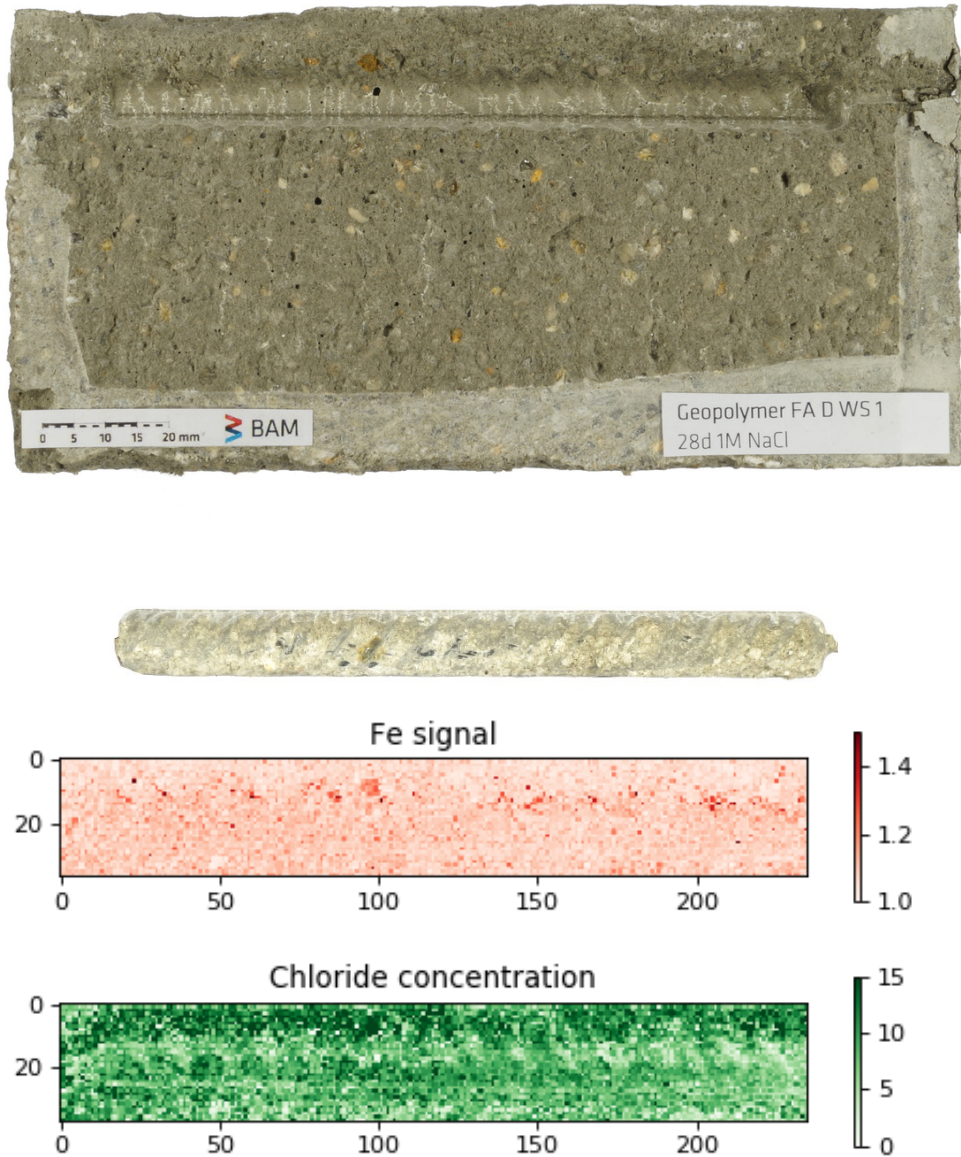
Foto von gespaltener FA D WS 1 Probe nach Depassivierung von Bewehrungsstahl mit Bewehrungsstahlzustand und die mittels LIBS identifizierte qualitative räumliche Verteilung von Fe und Cl im Stahlabdruckbereich.
